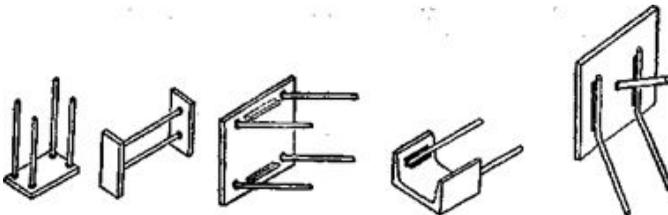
Типы закладных деталей сборных железобетонных элементов
